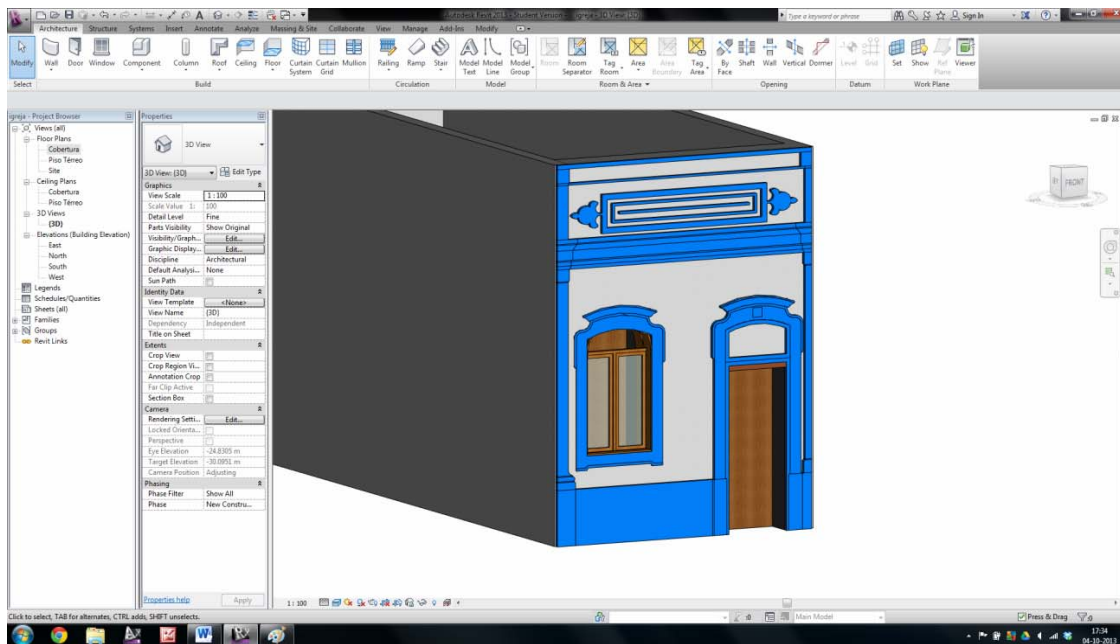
Fachada detalhada da moradia tipo “Igreja”.
